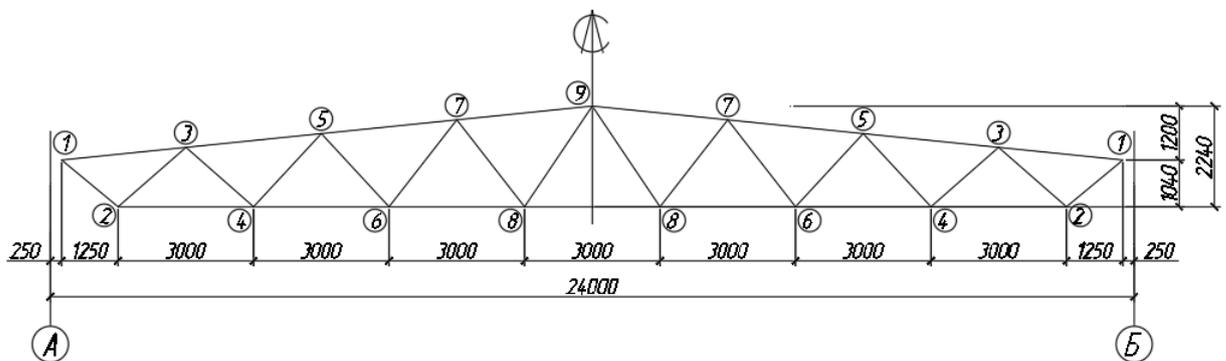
Обозначение узлов фермы к таблицам А.2-А.4
